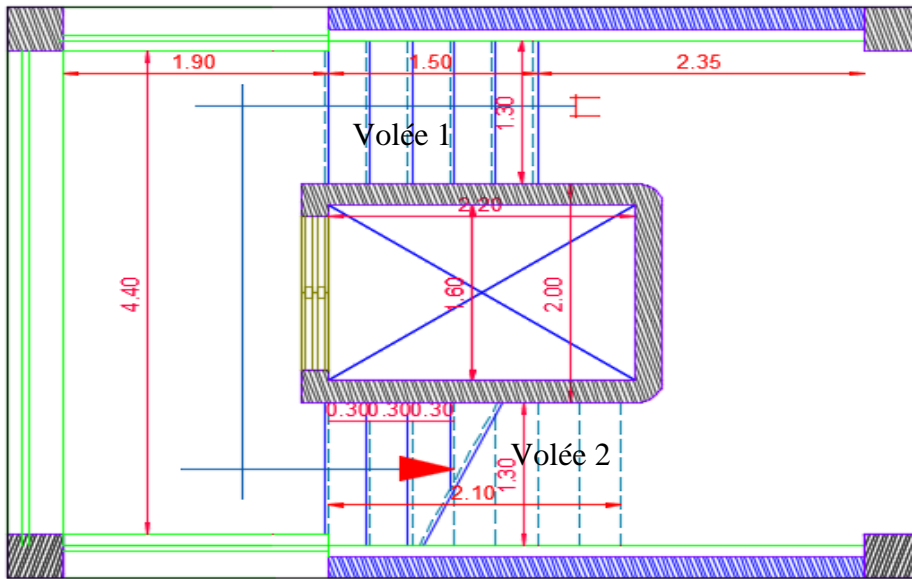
Vu en plan de l'escalier (Type 1).
